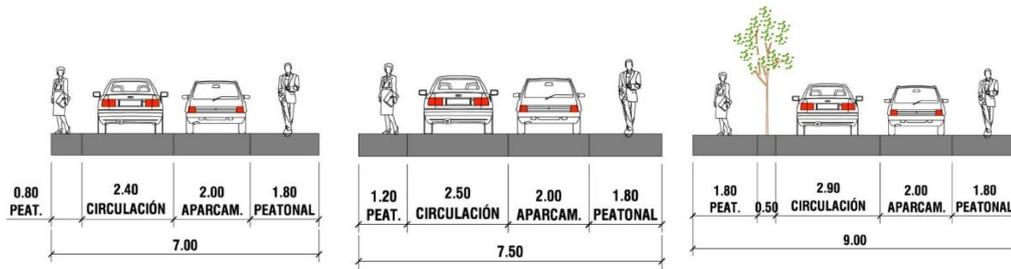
Propuesta de secciones para los viales interiores de la supermanzanas
